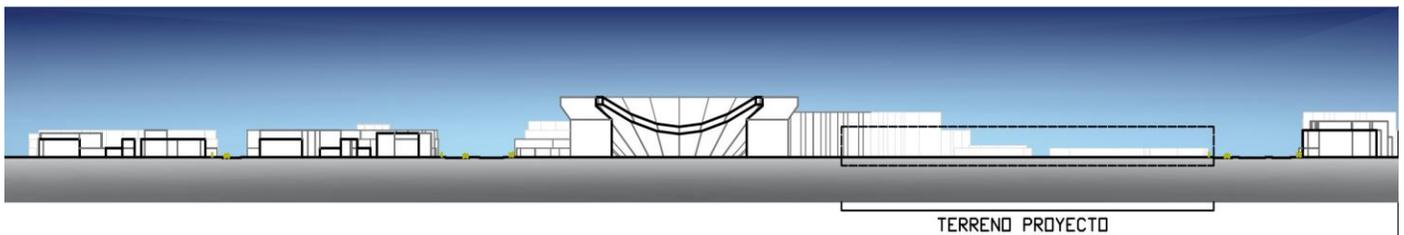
Corte Longitudinal B-B'. Elaboración grupal taller avanzado.
